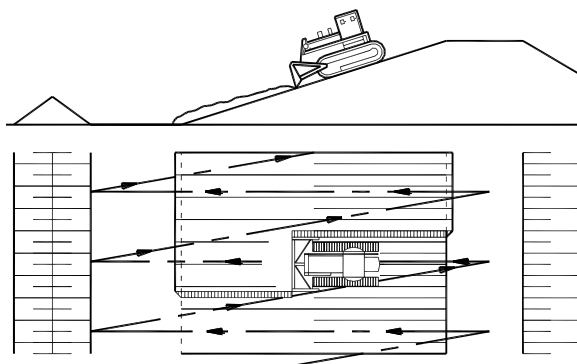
Схема планировки откоса насыпи бульдозером
